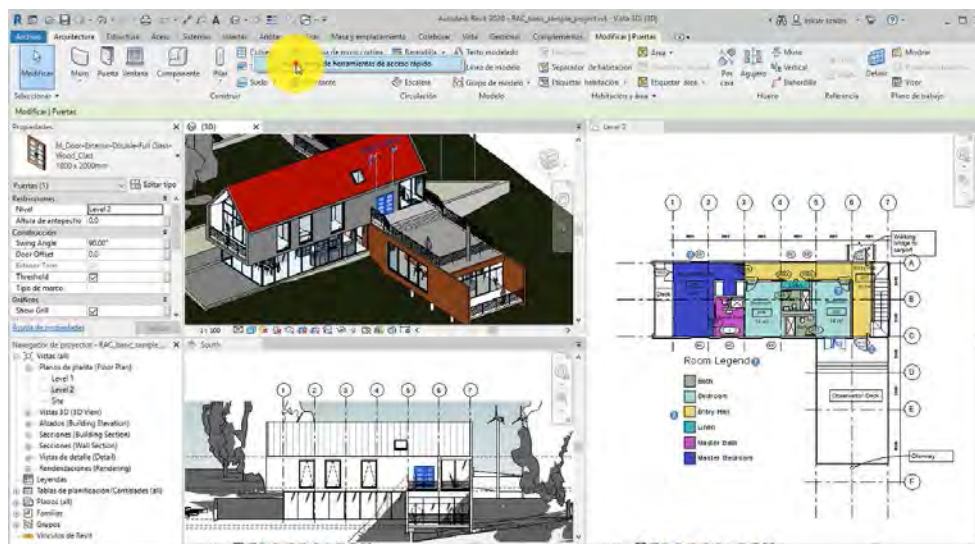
Vista 3D, Plano, y Fachada del Proyecto ejemplo Revit 2017
